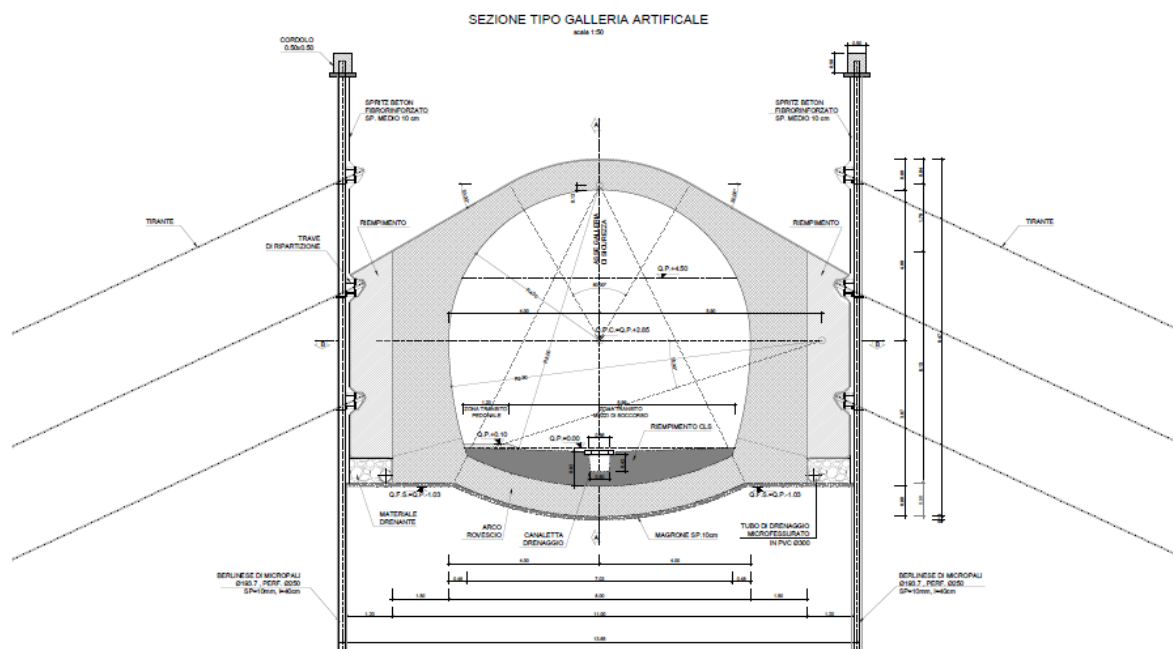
Sezione trasversale – galleria artificiale policentrica.
